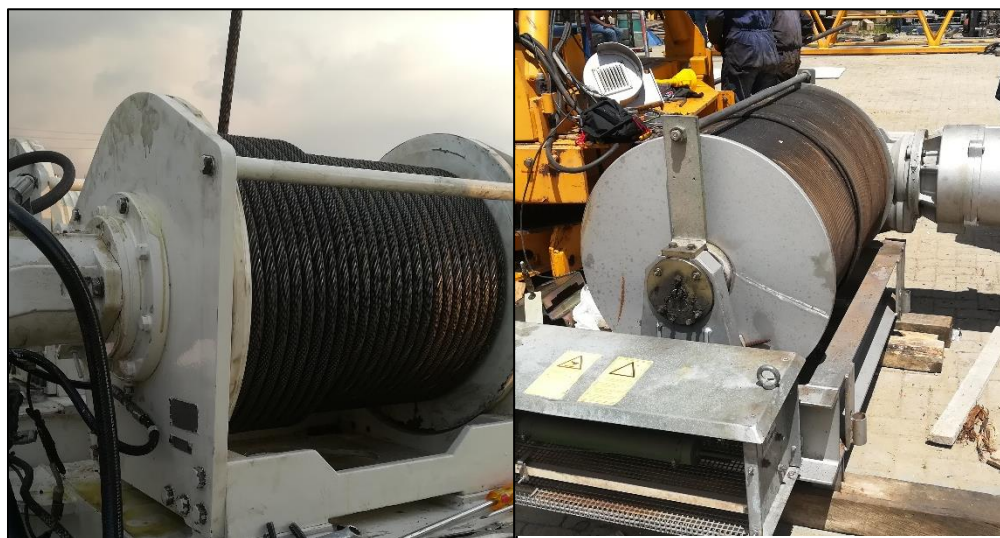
Winch o tambor de elevación. Fuente: Autor.
